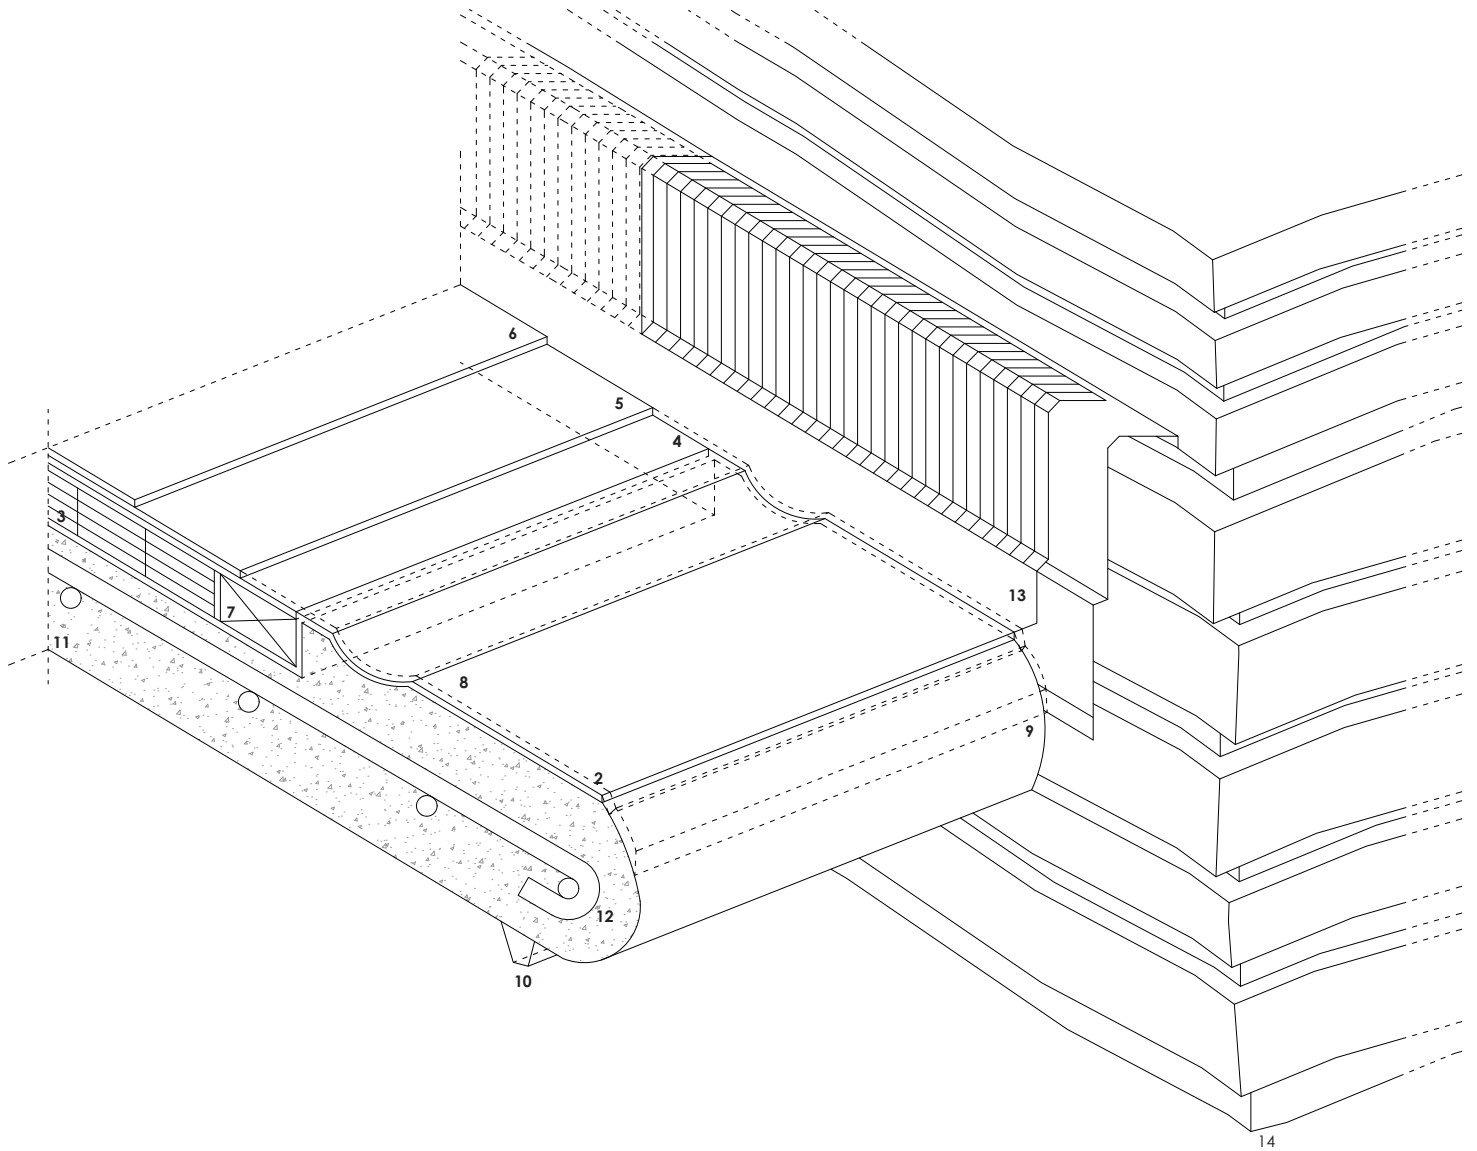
Axonometría detalle de restauración de cubierta no practicable
